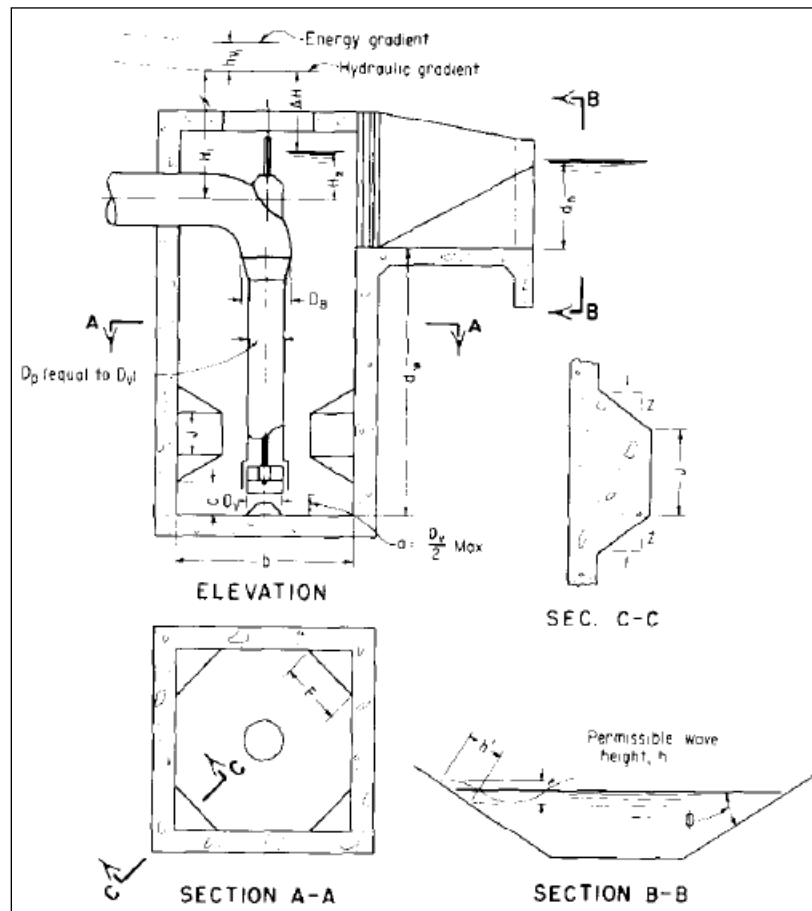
Válvula de Manguito típica con cámara de aquietamiento.
